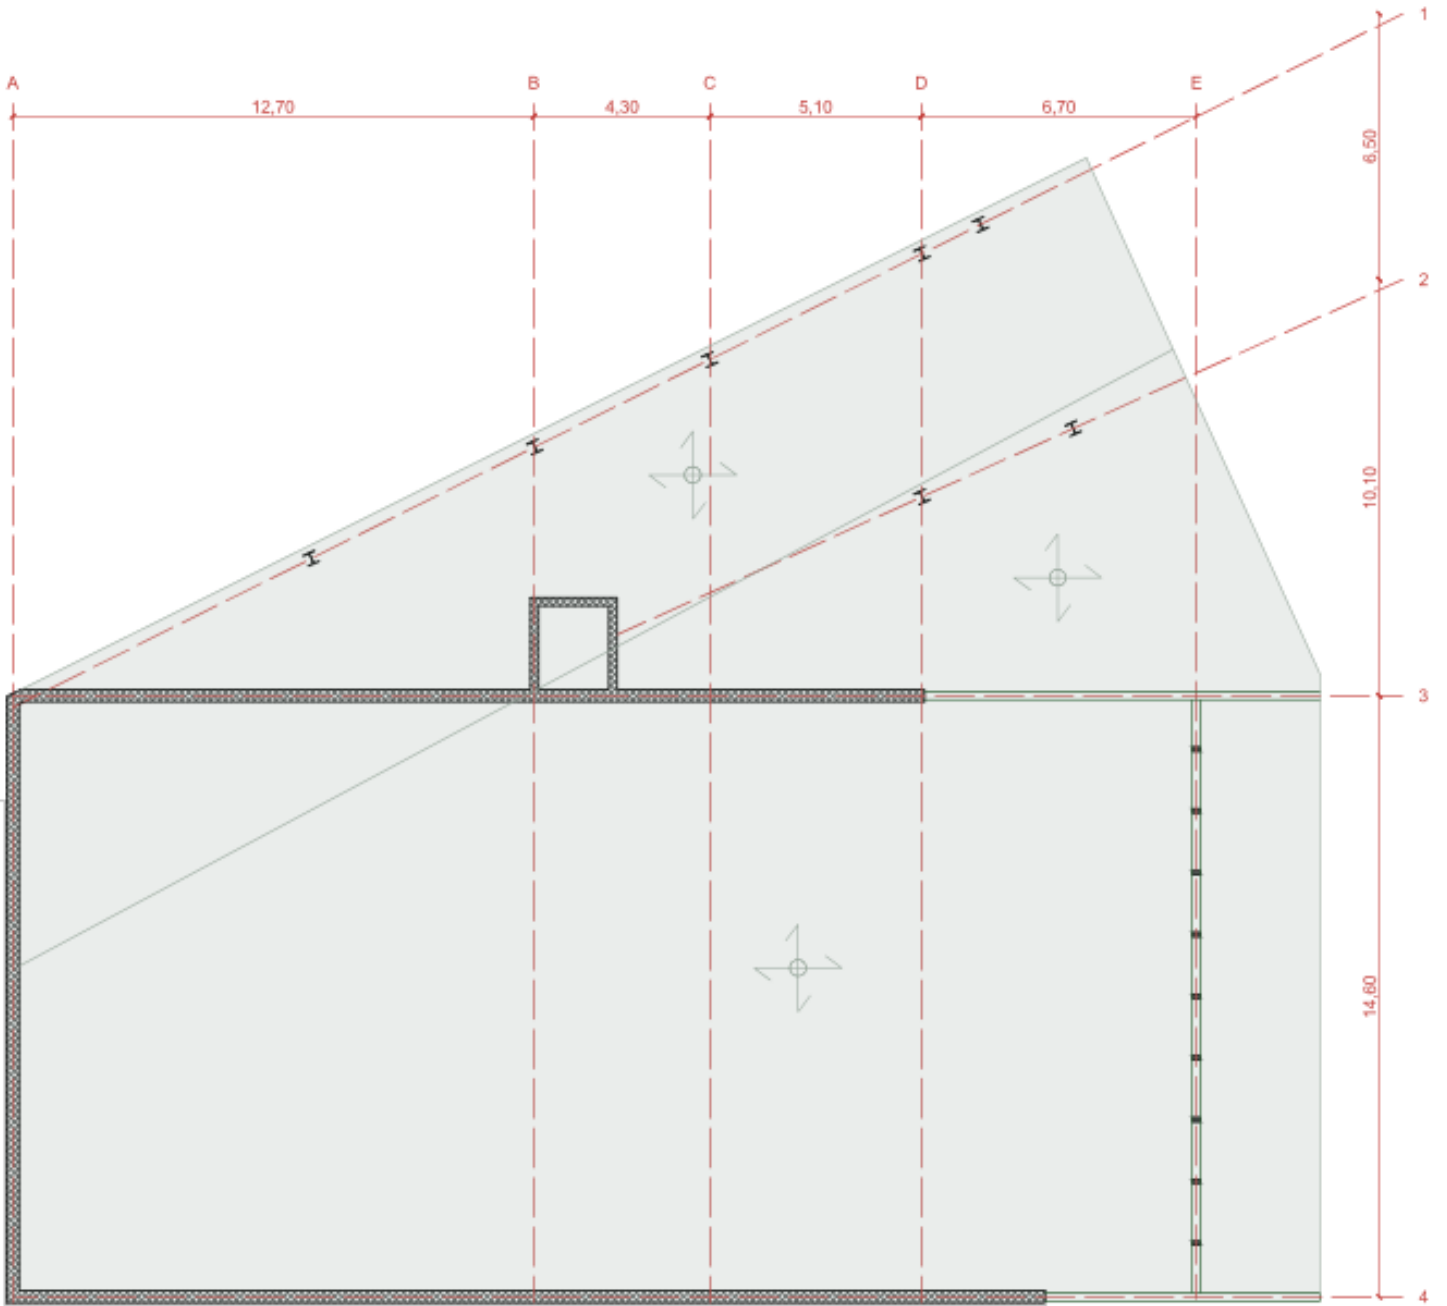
Pianta solaio copertura edificio auditorium
